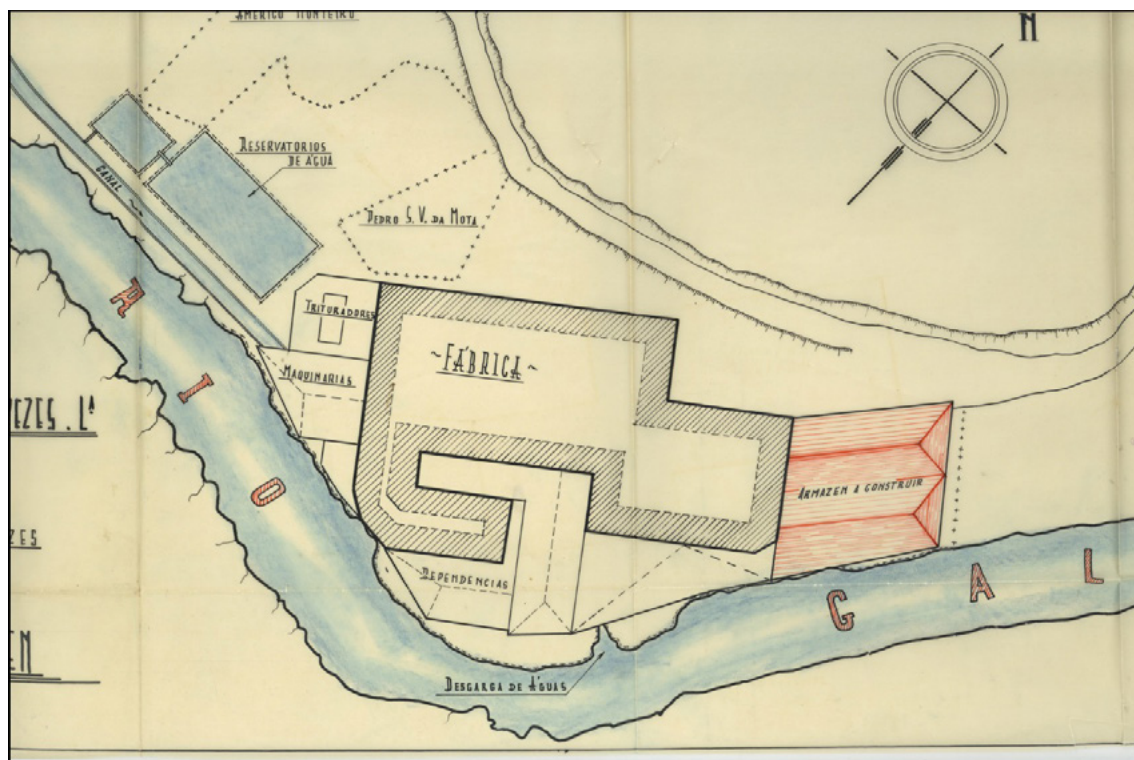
Planta com os armazéns a construir. Fonte: Arquivo APA.
